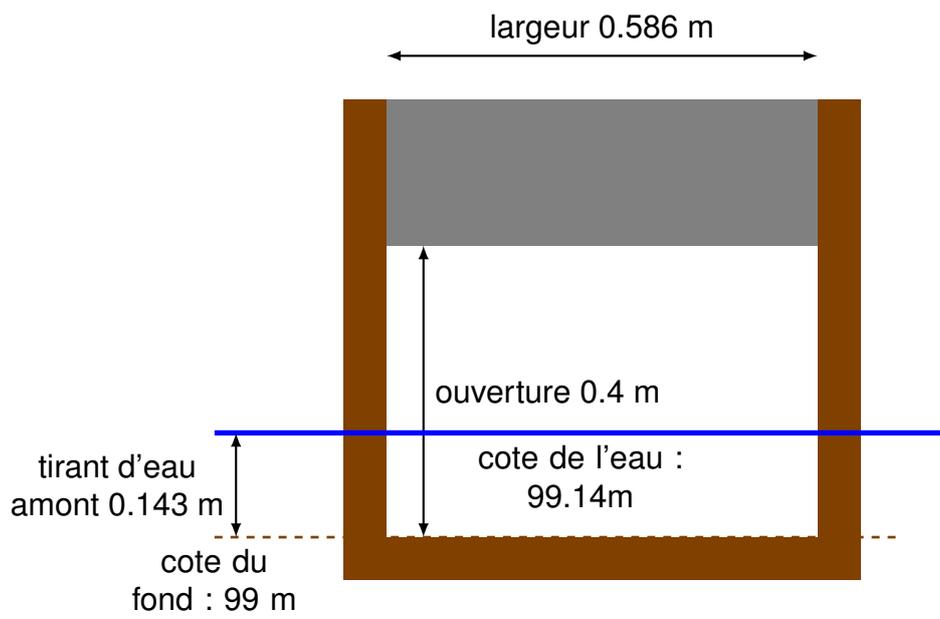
Coupe transversale de la vanne martelière située à l'aval dans le canal
